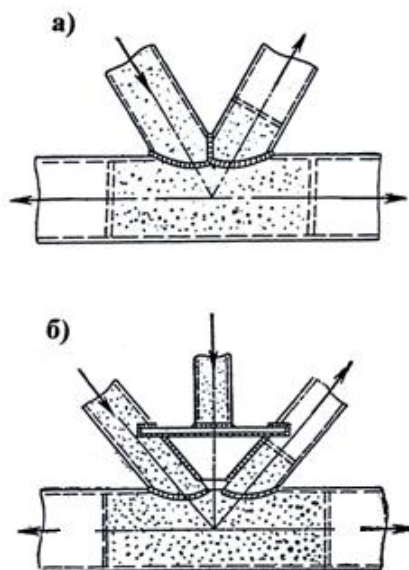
Узловые соединения металлических ферм из труб заполненных бетонными пробками [2]
